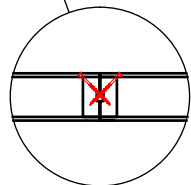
Schemi di collegamento tra fondazioni e solaio
